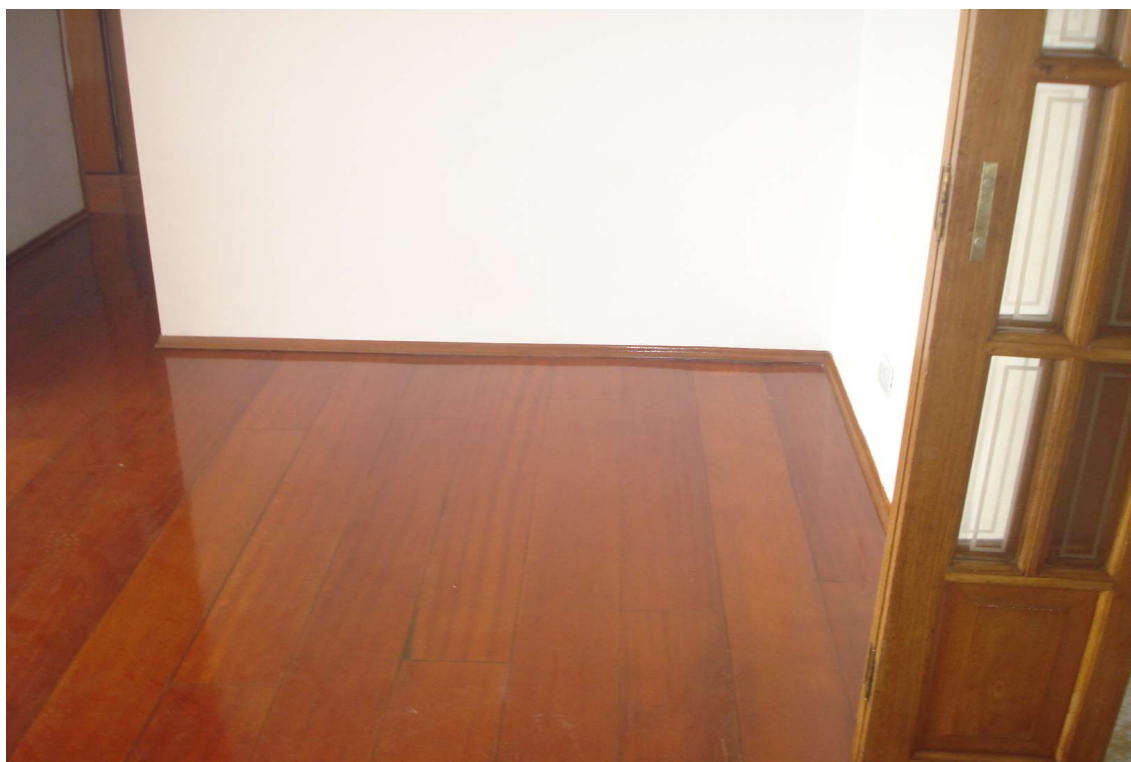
Vista de outro ângulo da sala no apartamento paradigma.
